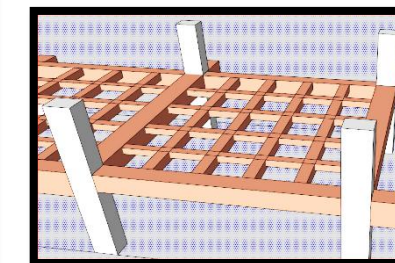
photo représente détail d'assemblage poteau/poutre,Src :auteur
